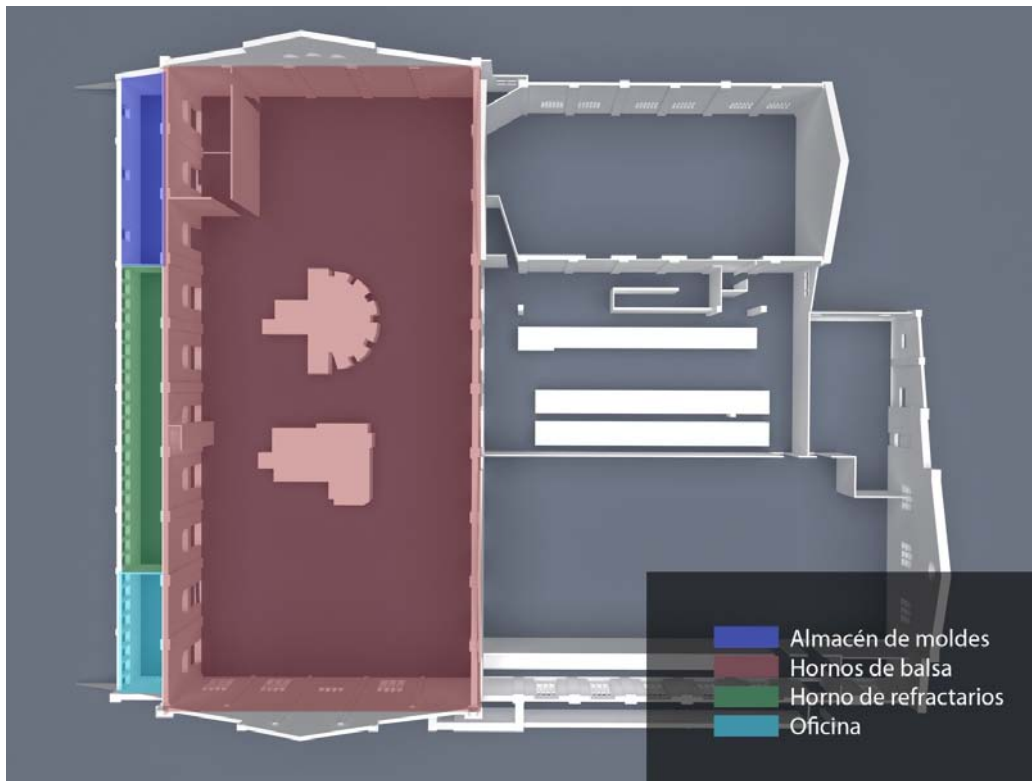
Distribución en planta (Primera planta (nave1)).
